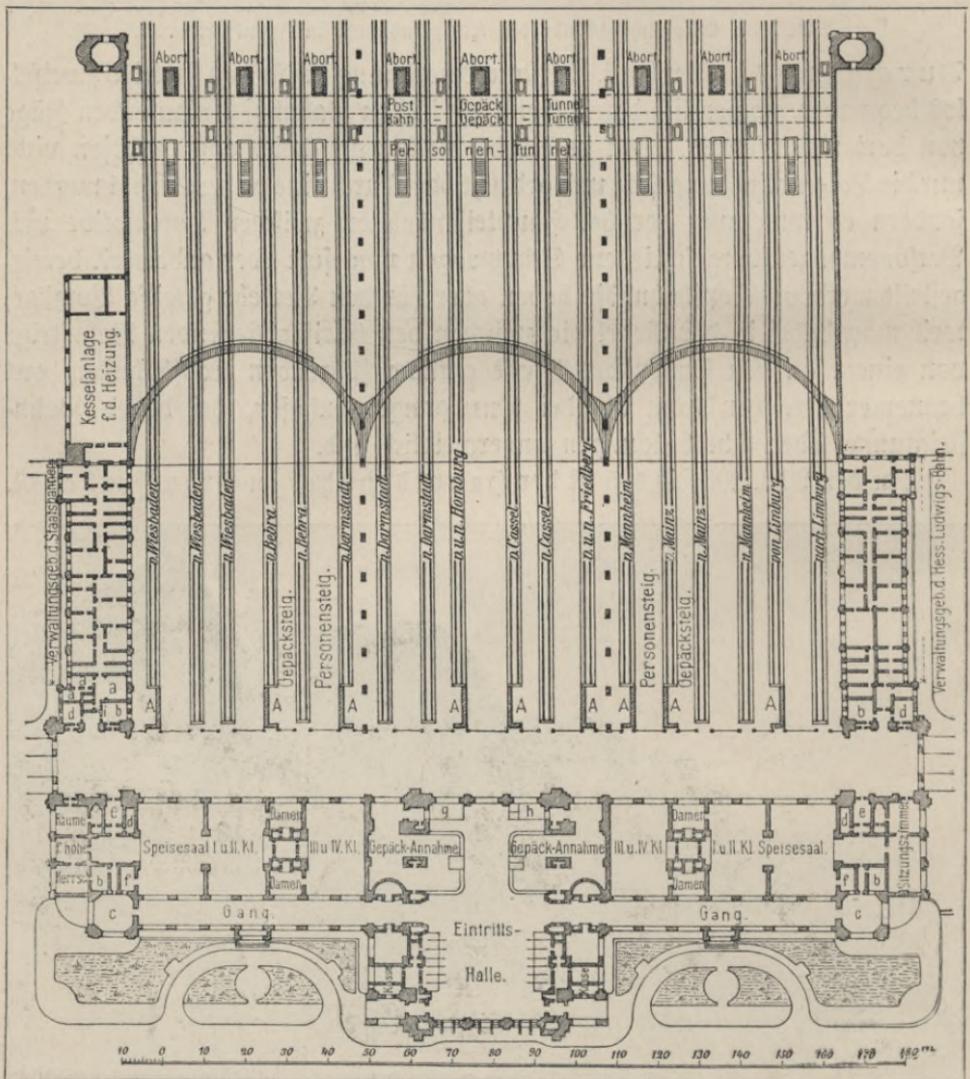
Grundriß des Hauptbahnhofs in Frankfurt a. M.
